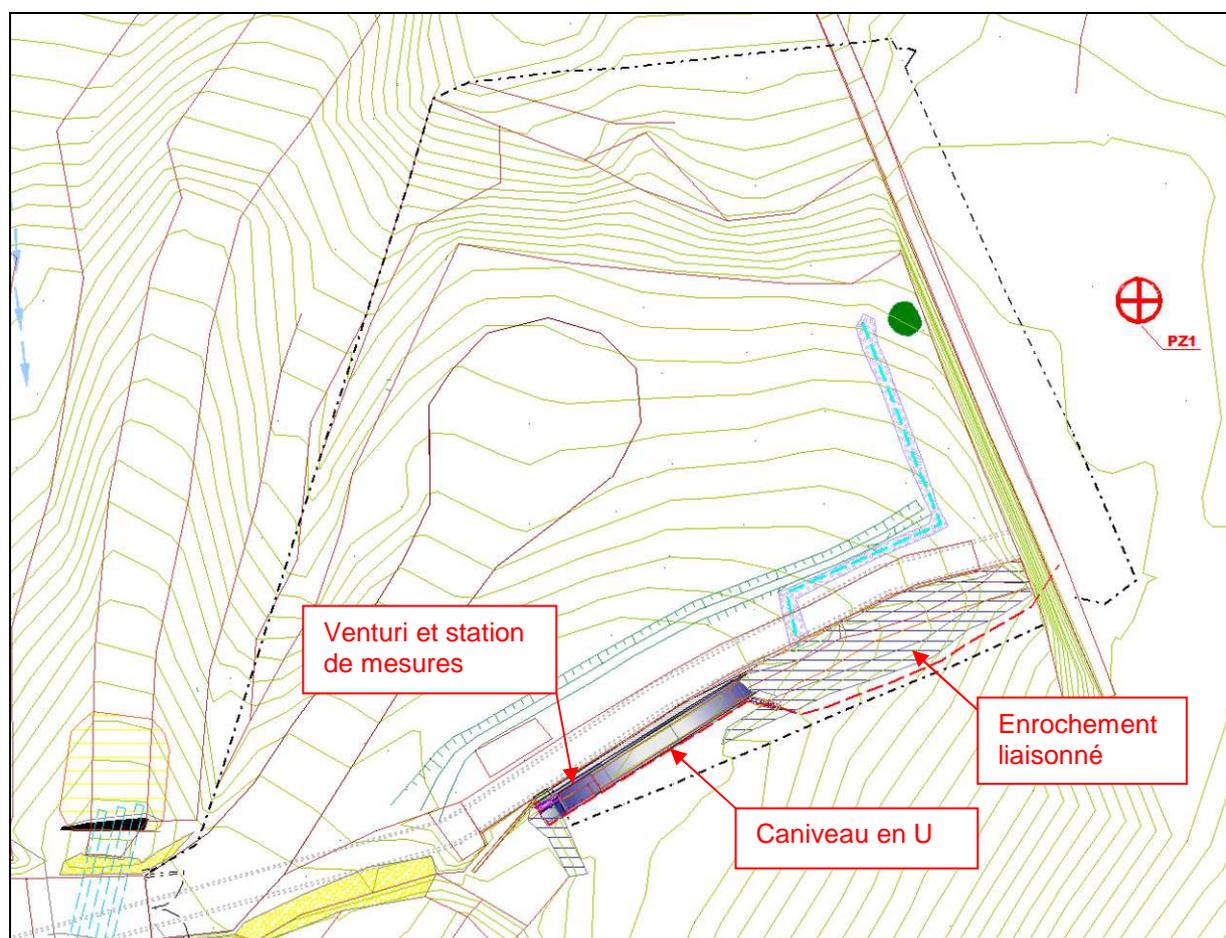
Localisation du canal de mesures en pied du mur de soutènement
